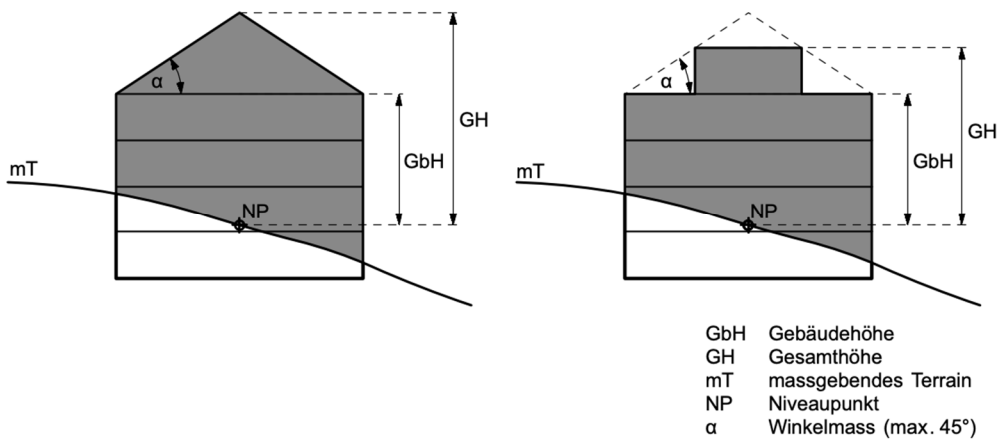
Schnittpunkt „Fassade-Dachoberkante“
